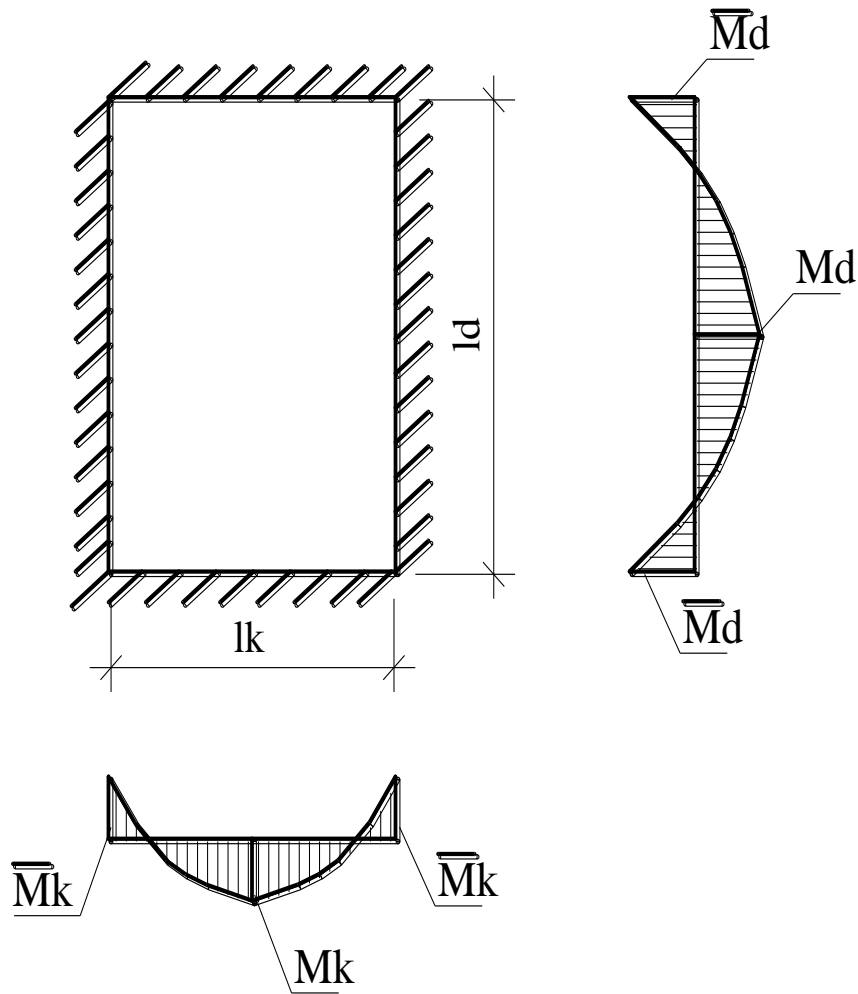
Схеми монолітної плити, затисненої з 4-х сторін
